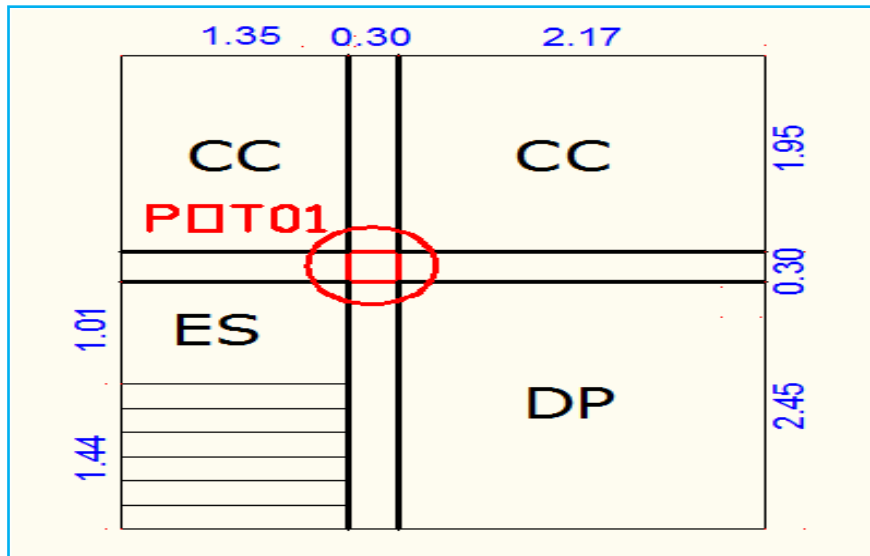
Surface afférente du poteau 01 (poteau de la cage d'escalier)
